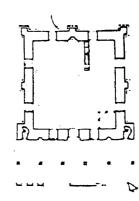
مسقط أفقى لجامع فيروز أغا فى استانبول (عن: Goodwin).
